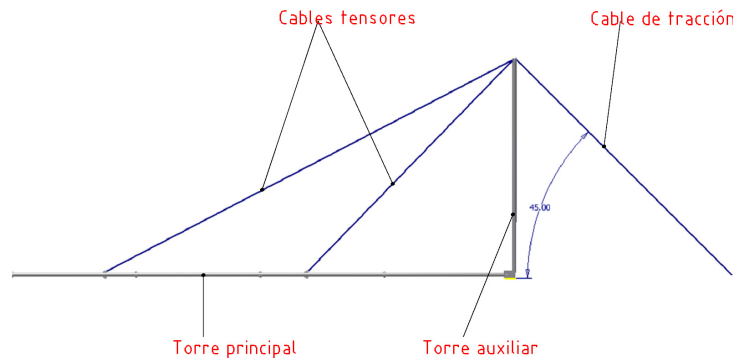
Esquema de montaje (sin cable superior auxiliar)
